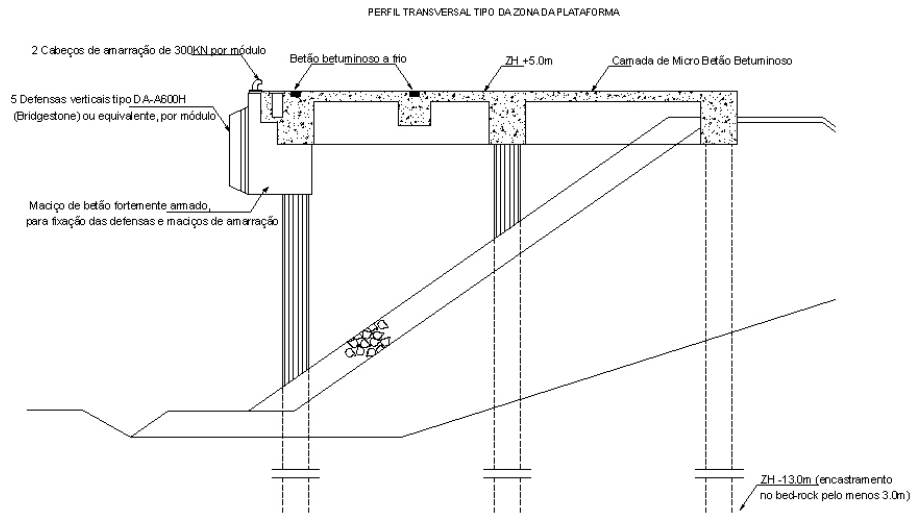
Perfil esquemático transversal da estrutura proposta.
